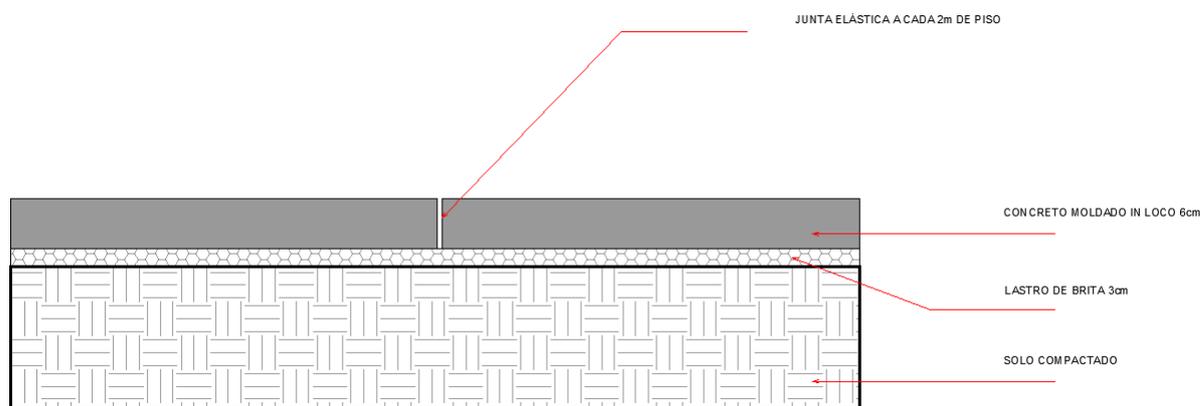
CORTE ESQUEMÁTICO JUNTAS DE DILATAÇÃO – CALÇADA EM CONCRETO
